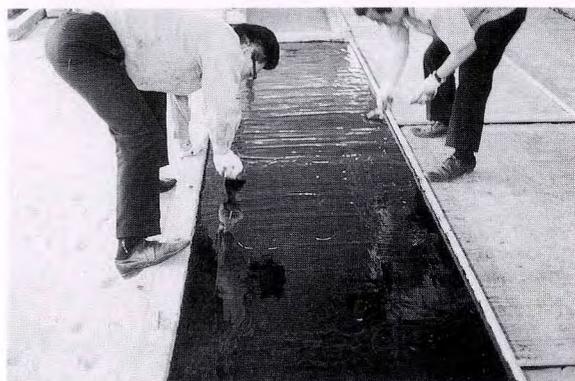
塗膜防水とシート防水の施工性とその保護層に関する実験：タールウレタンの施工状況（1970年）
